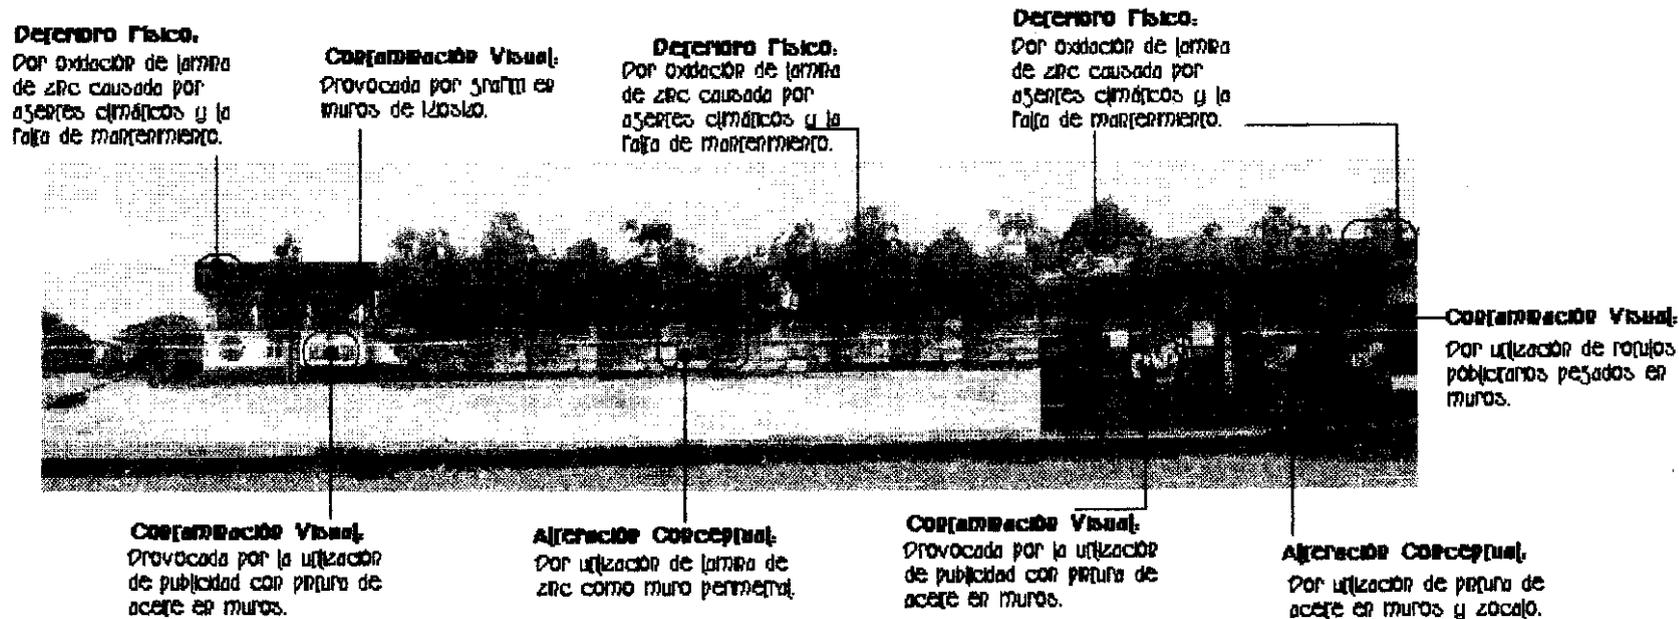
Edificaciones ubicadas hacia el lado sur de la ermita (fuente: autora, mayo de 1999)
